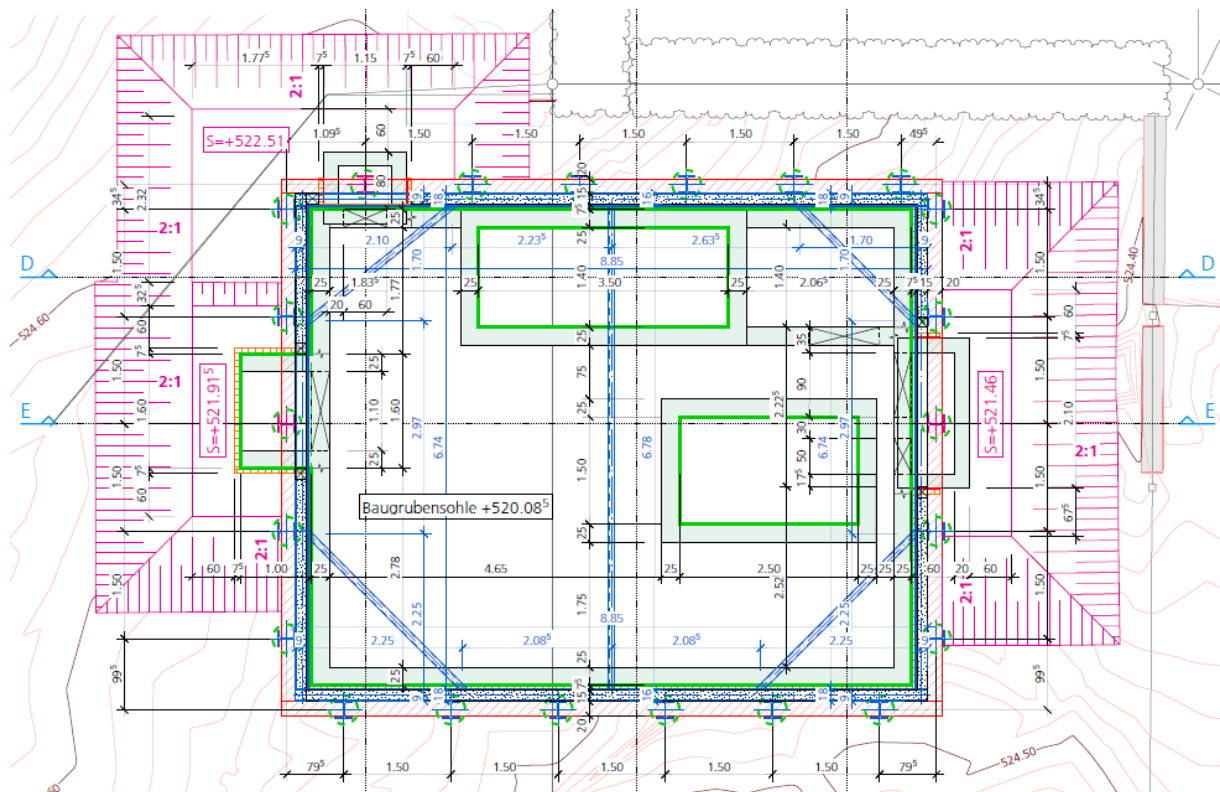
Grundriss Baugrube Mühlemattstrasse
